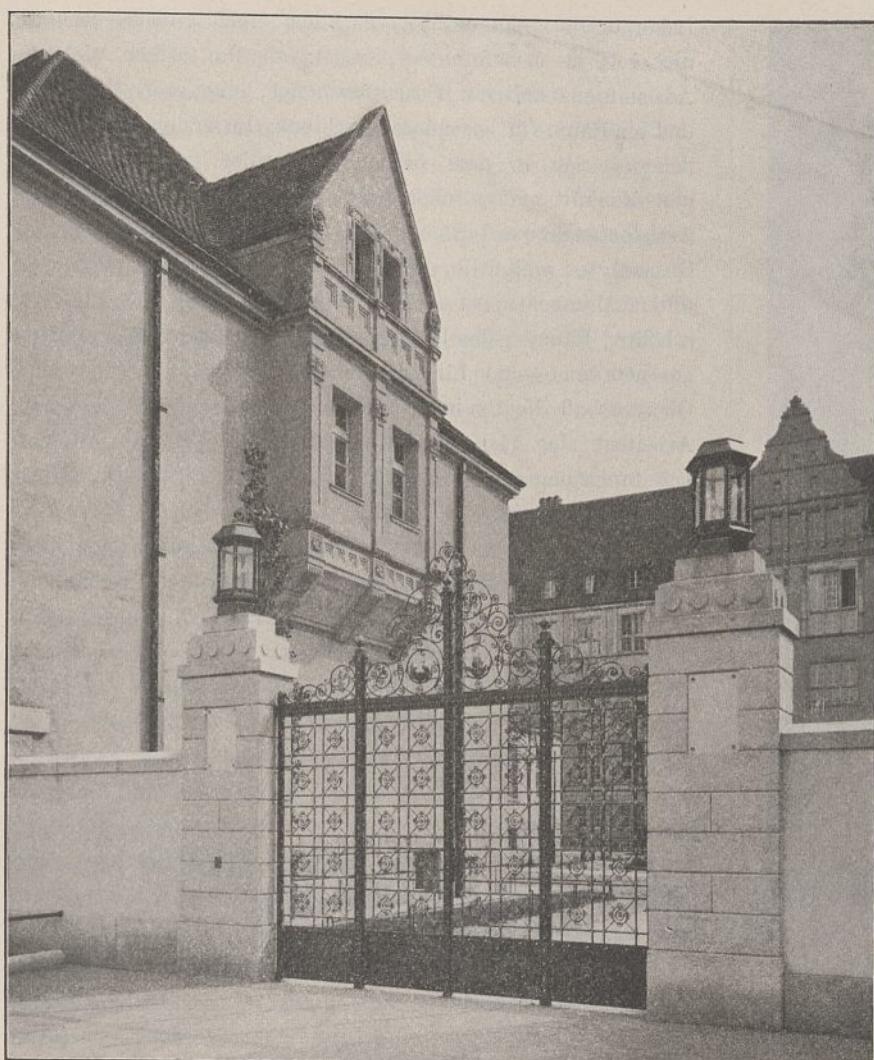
Maschinenlaboratorium. Westlicher Anbau mit Erker und Haupttor.
